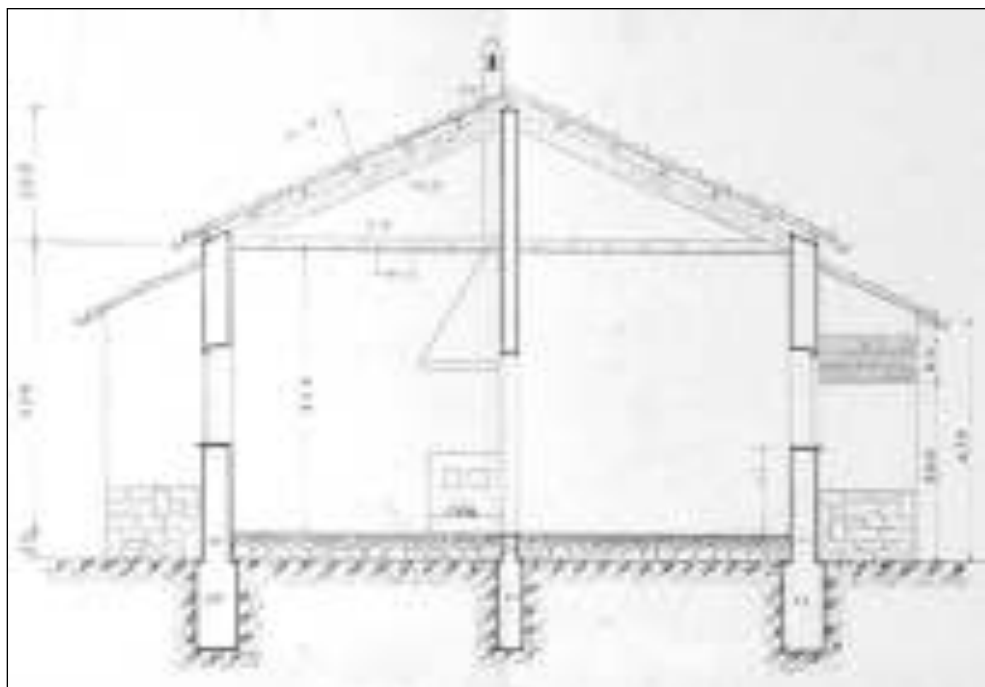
Casa Colonica nel Metapontino (MT): Sezione - Archivio ERSAP
